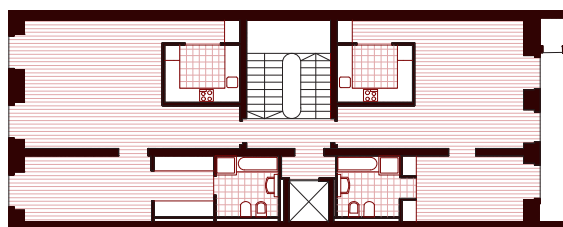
Planta tipo habitação Quarteirão das Cardosas
